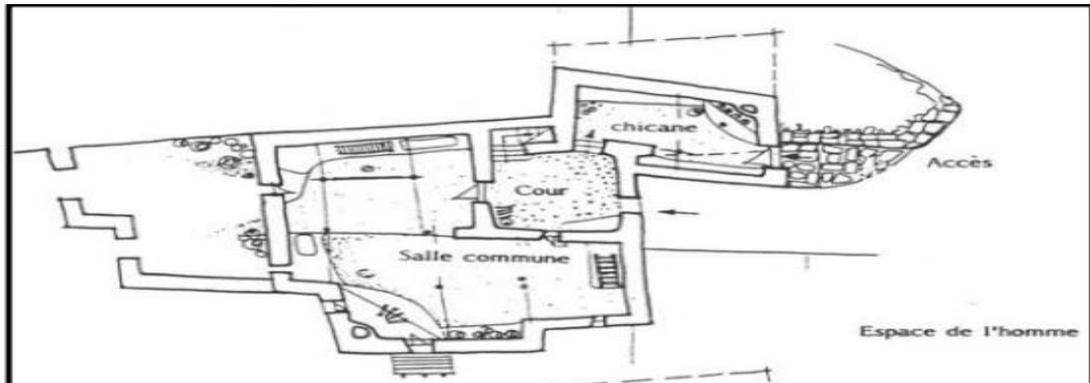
Plan du 3^{eme} niveau d'une maison Chaoui [14].
